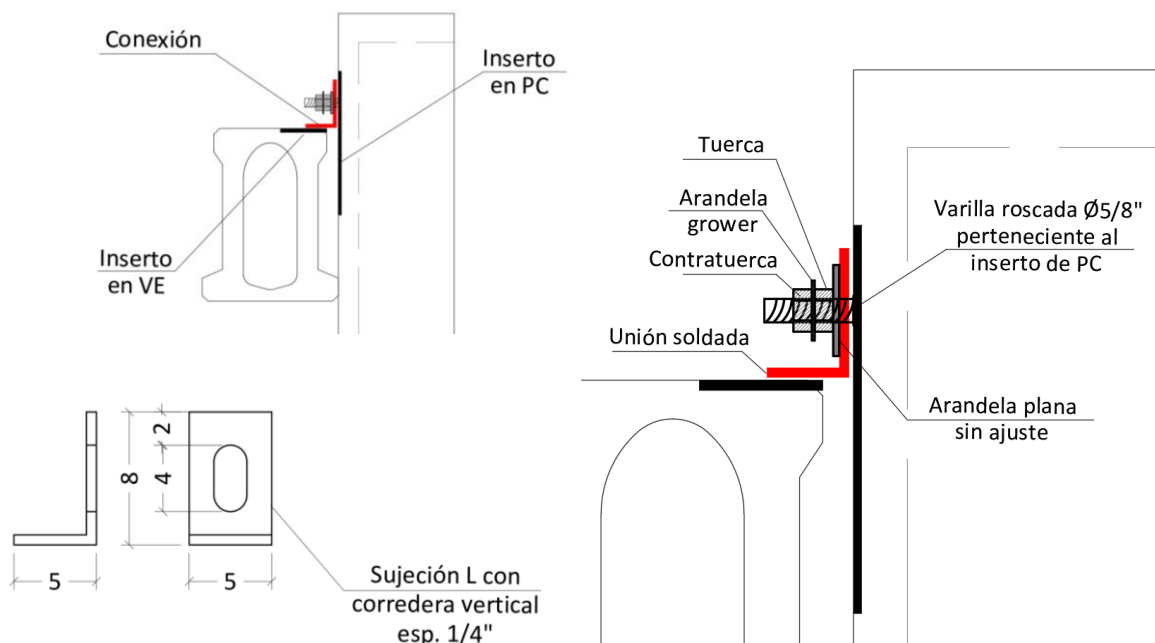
Vinculación de vigas de cubierta y paneles de cerramiento
